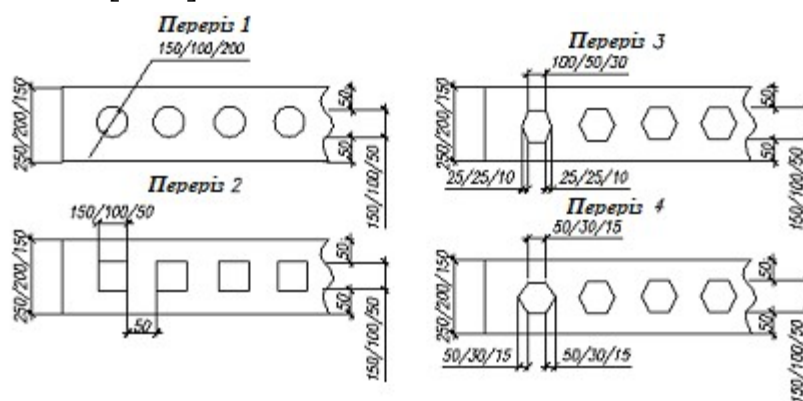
Схеми плит перекриттів з різними формами перерізу пустот [7]
